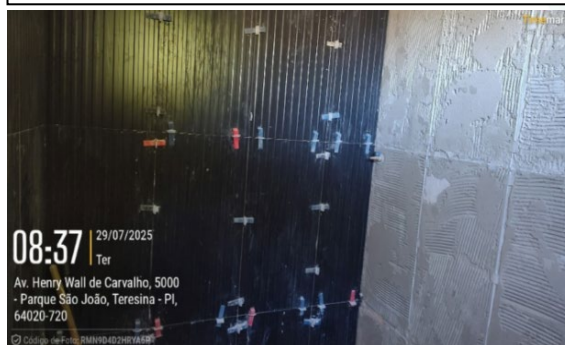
Execução de revestimento cerâmico nas paredes do banheiro.
